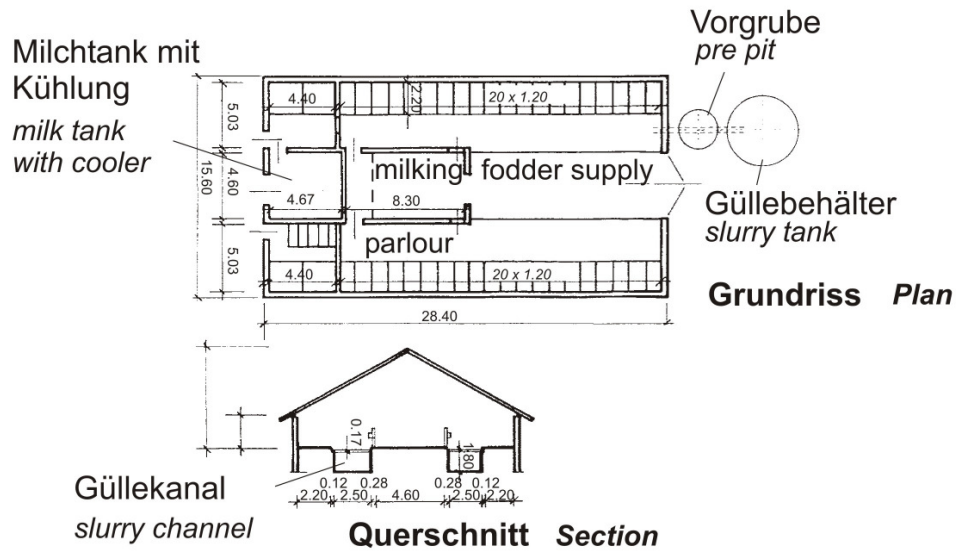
Grundriss und Schnitt eines Laufstalls für 40 Kühe
